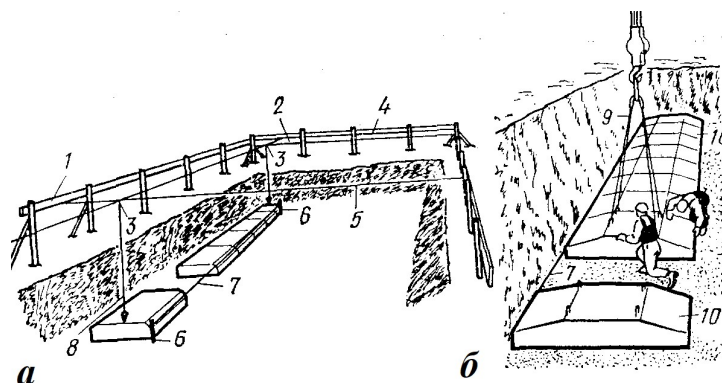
Монтаж стрічкових фундаментів: а – перенесення осей фундаментів на дно котловану; б – схема установки блоків-подушок; 1 – поперечна вісь; 2 – поздовжня вісь; 3 – точки перетинання осей; 4 – обнесення; 5 – осьова струна; 6 – штирі для кріплення дроту-причалки; 7 – причалка; 8 – схил; 9 – чотирирівтковий строп; 10 – маяковий блок
